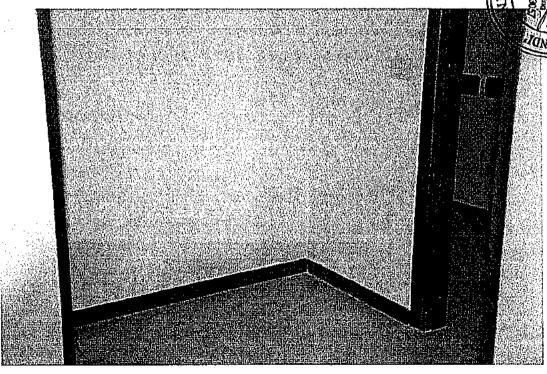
Parete del vano lato nord est al confine con il bagno a lavori eseguiti
